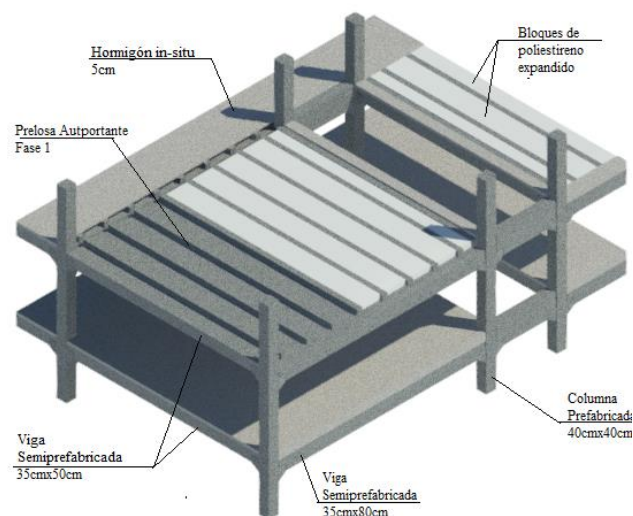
4. Losas prefabricadas en edificio prefabricado
